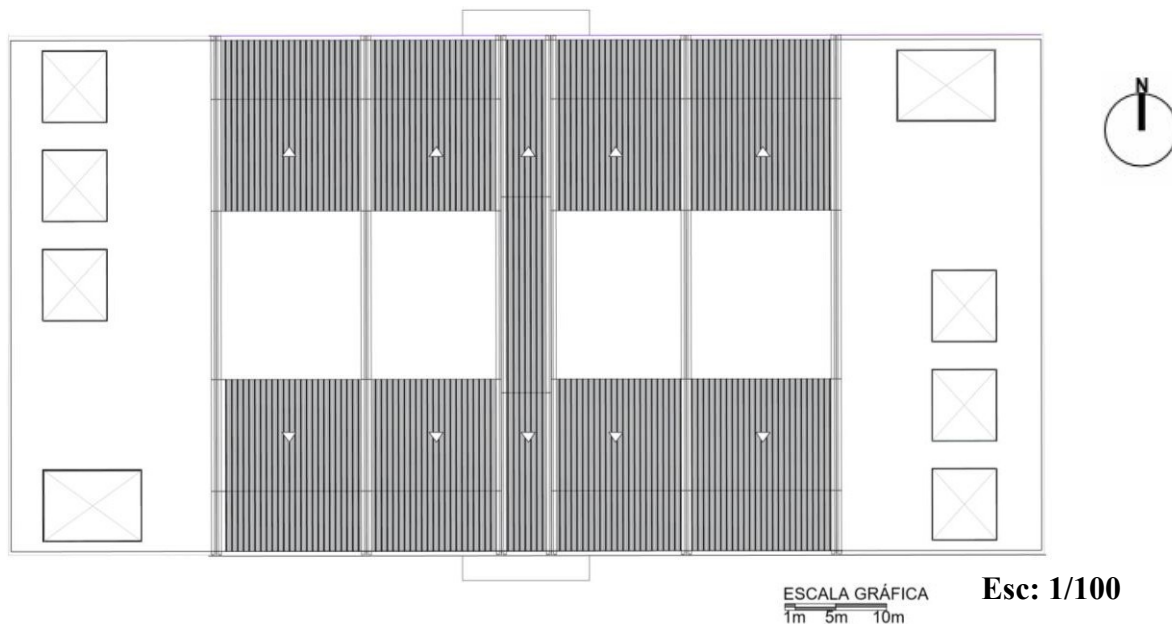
Plano de cubiertas Escenario Múltiple Voley-Basquet
